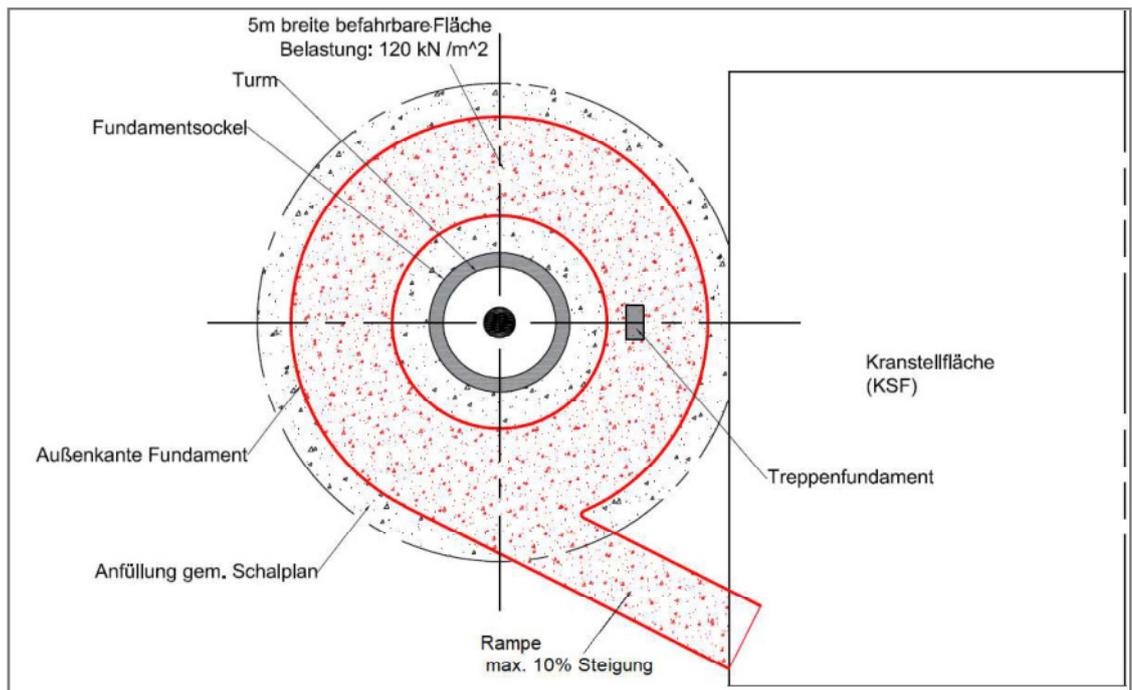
Fläche um den Turm in Draufsicht, Stahlrohrturm mit Außenflansch
